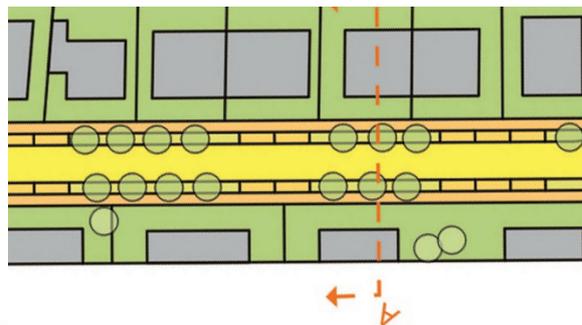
Straßenprofil Germergasse, Stadtareal Baden
